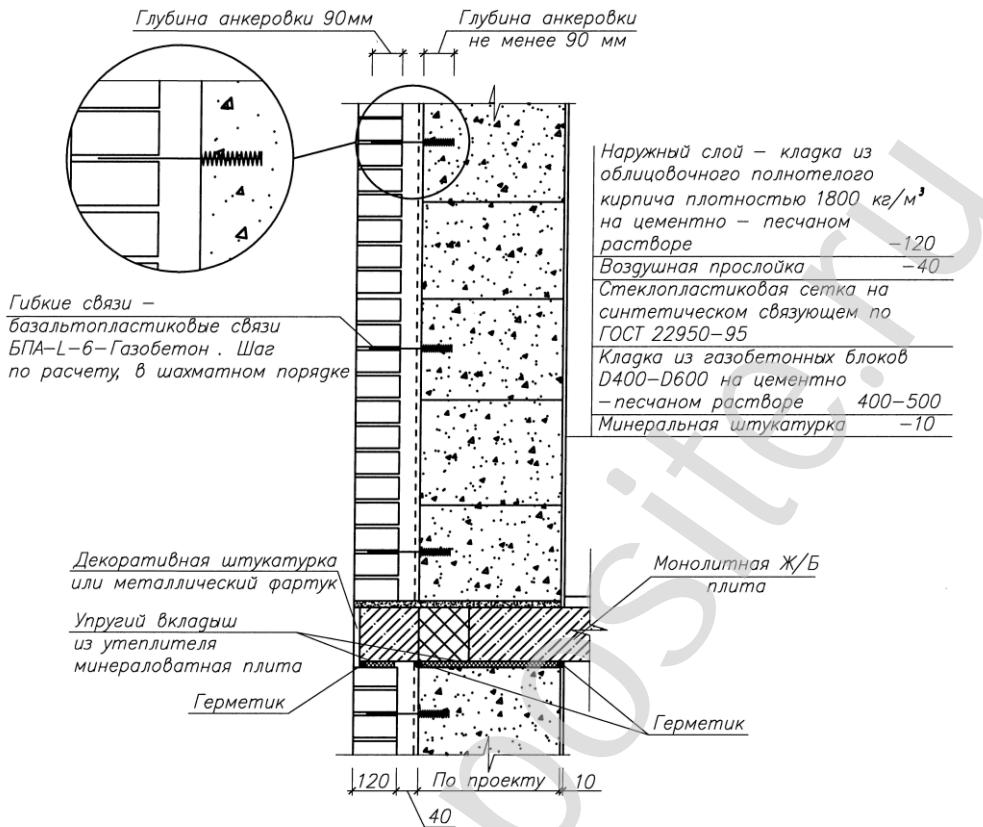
Поперечное сечение стены и схема расположения слоев с применением газобетона без дополнительного утеплителя
